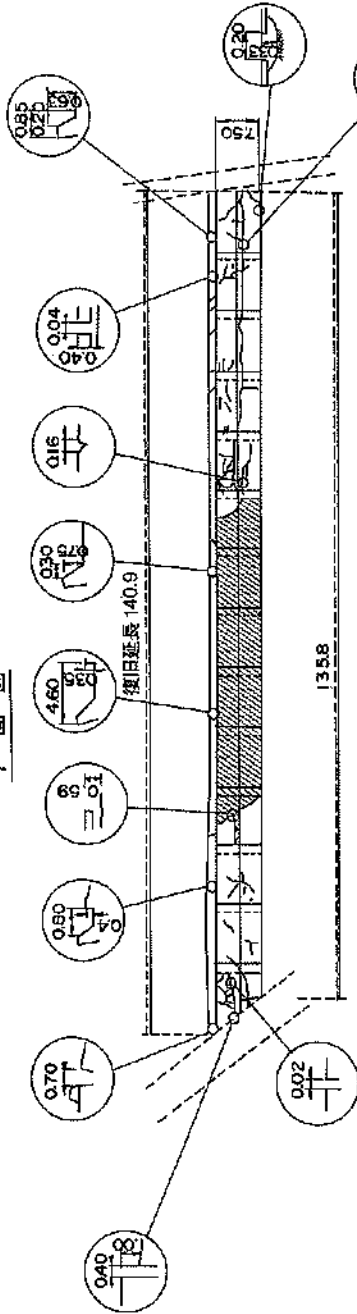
奥尻港南防波堤の被災状況平面図・縦断面図・断面図
